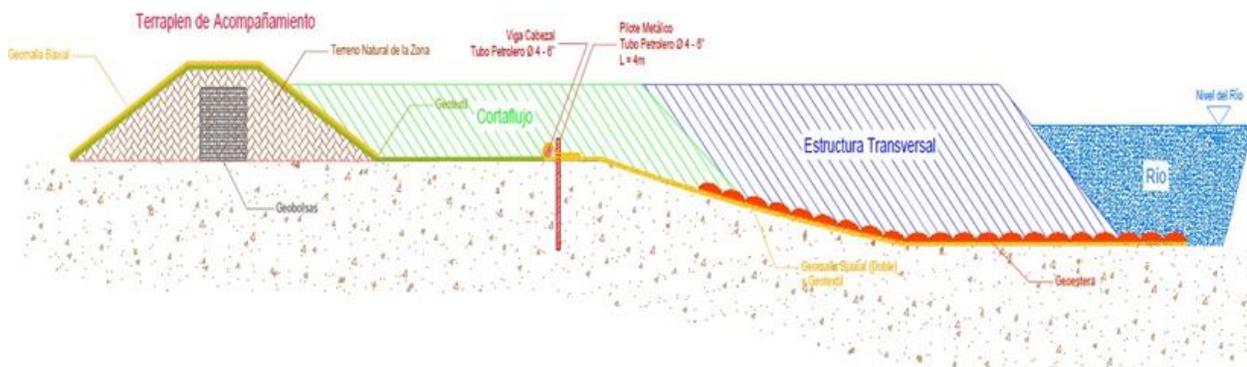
Fuente: planos formulación del proyecto – Viga cabezal y pilote de 6" para fijación de orillas
